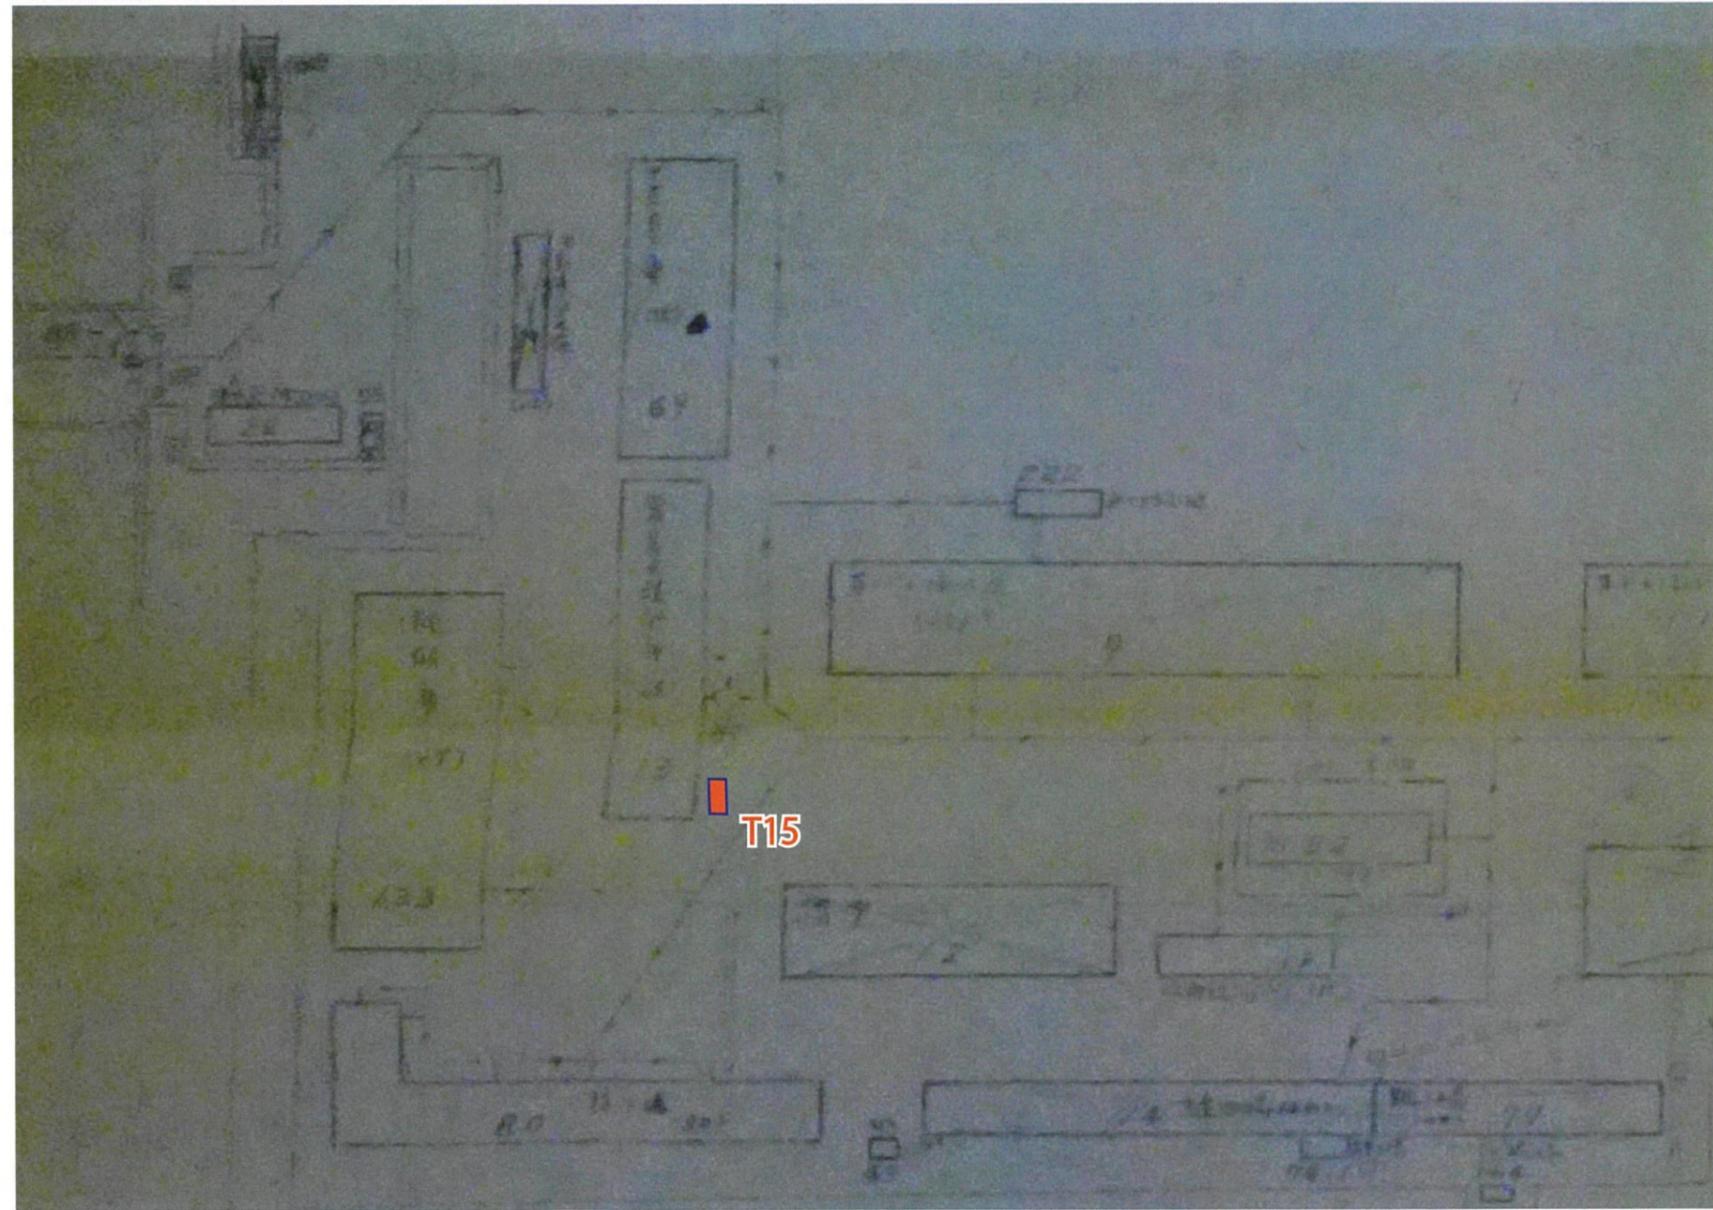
博物館 明治村所蔵「歩兵第六連隊平面図集 平面図」拡大図2
